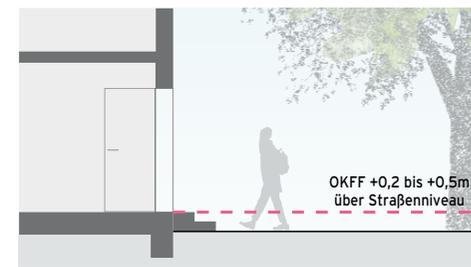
| Höhe Oberkante Fertigfußboden (OKFF) Erdgeschoss
